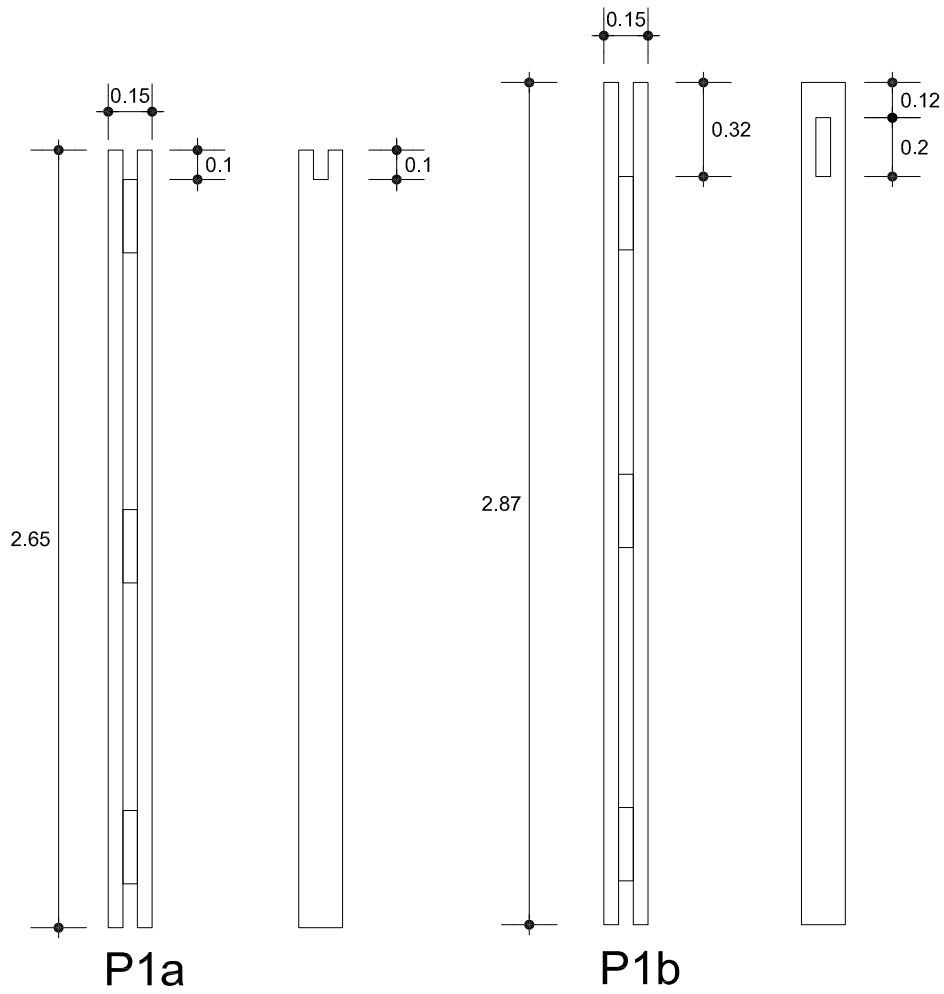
detalle de encastrado de paneles prediseñados con elementos estructurales
